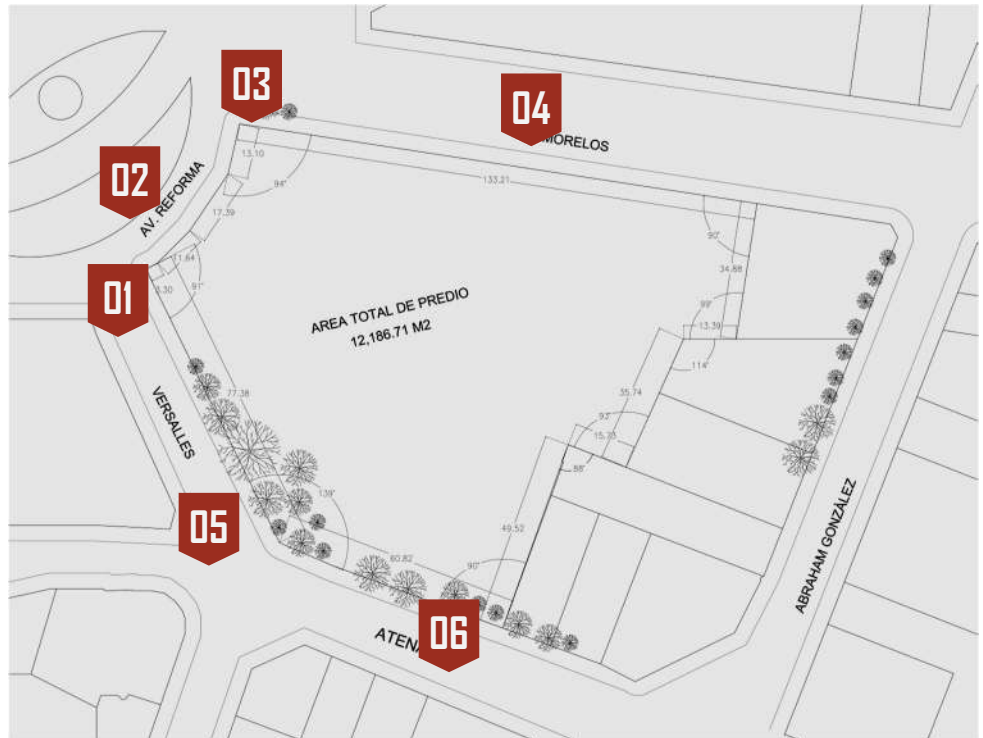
Planta Arquitectónica del terreno (Autoría propia)
